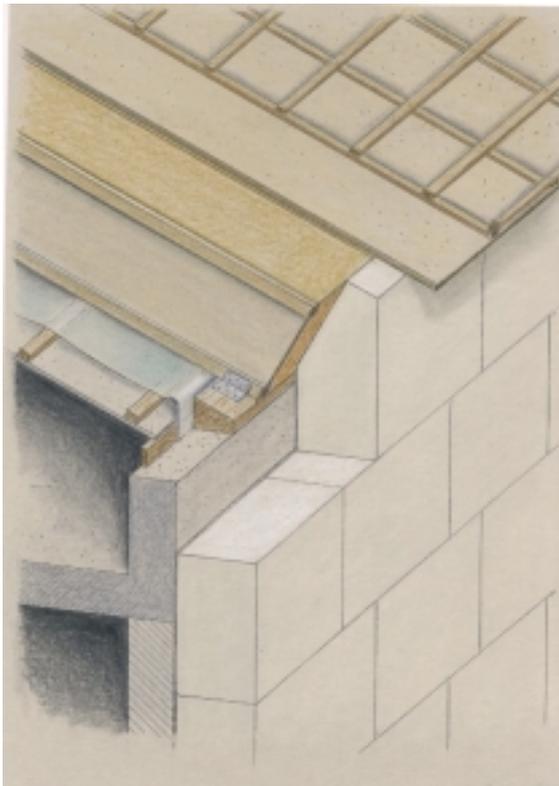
Anschlussdetail Ortgang, Massive wand an Holz-Leichtbau Dach. Die Mauerkrone ist hier nicht, wie sonst üblich in die Dämmebene des Daches hochgezogen.
